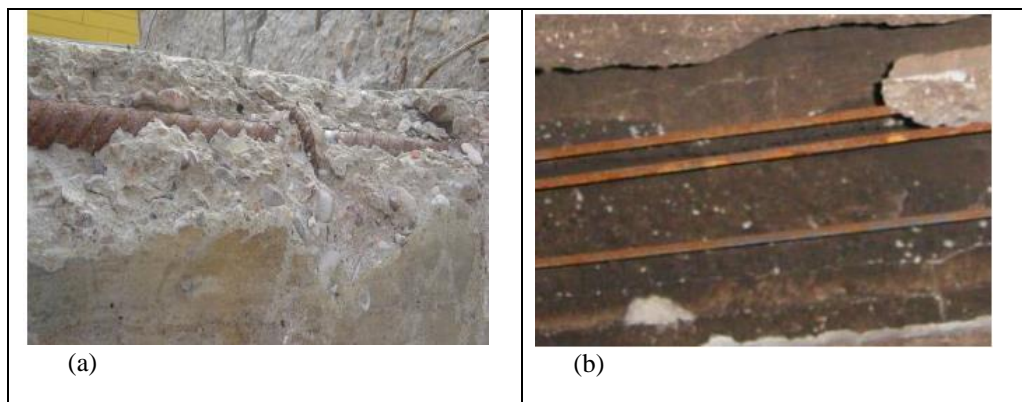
a) armadura expuesta en esquina en viga. b) Explosión en vigueta pretensada y acero expuesto tras saltado del recubrimiento.
